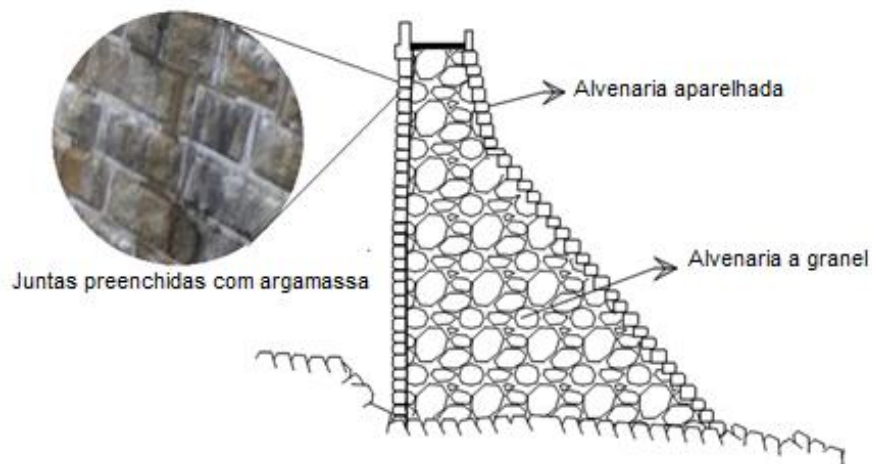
Materiais utilizados na construção das barragens de alvenaria.
